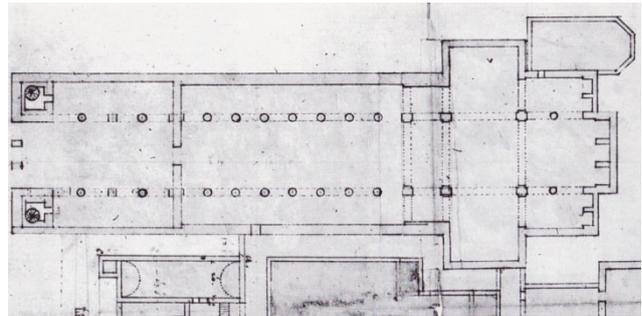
Grundriss des Baudirektors G. F. Majer 1739
